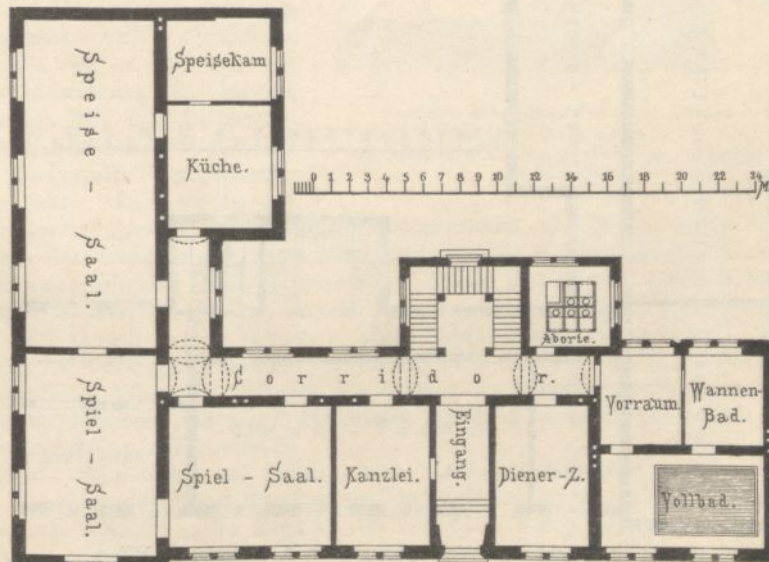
Erdgeschoss des Waisenhauses im X. Bezirke zu Wien.
